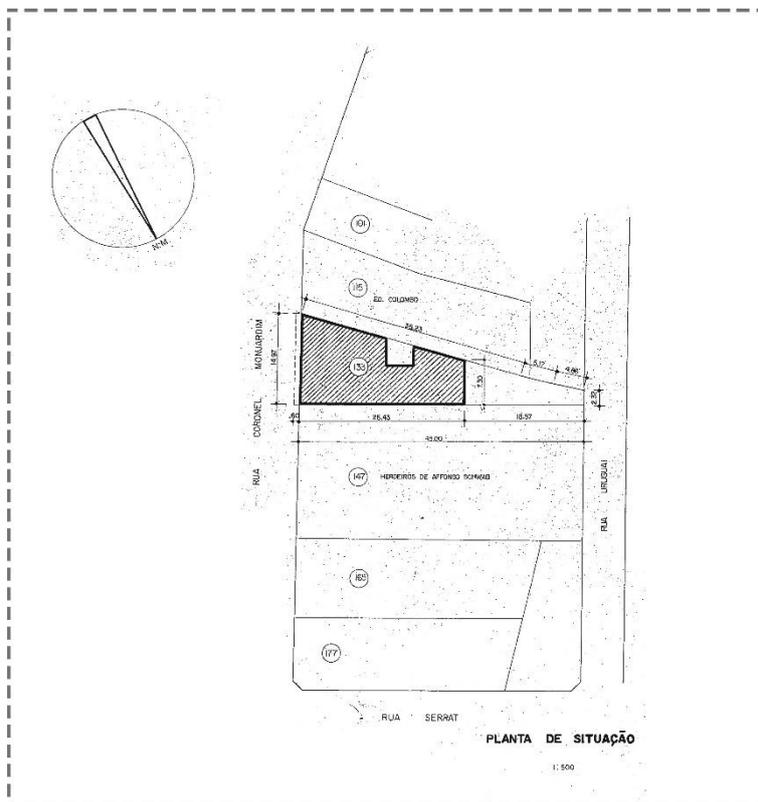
Detalhe planta de implantação do Ed. Fabíola.
